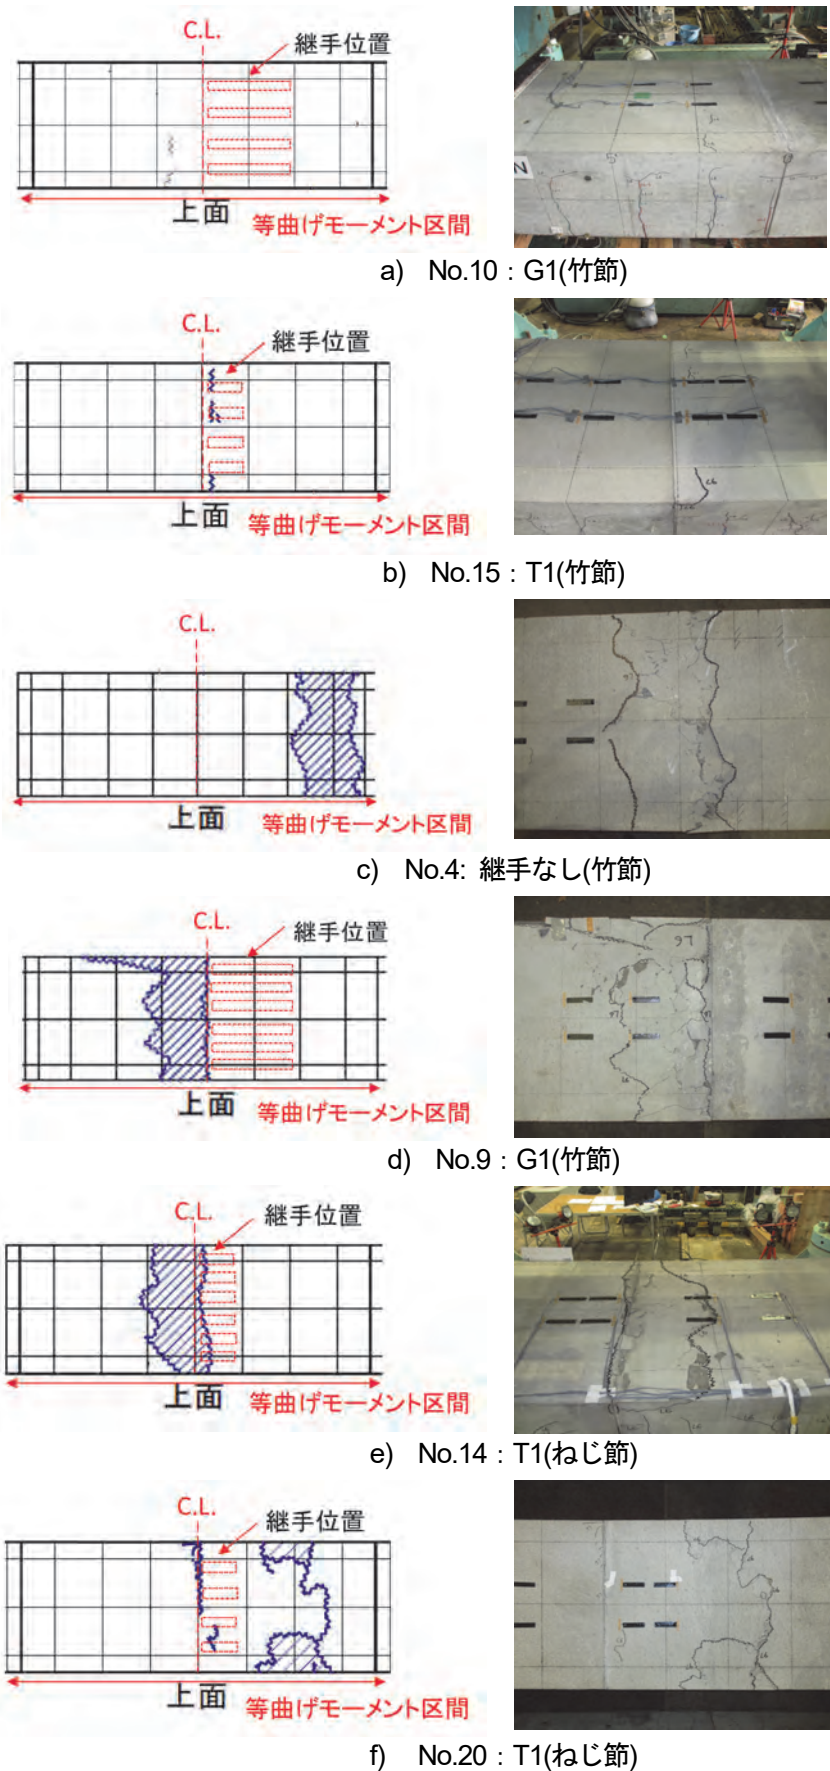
圧壊の発生状況（斜線部：圧壊部、波線：剥離によるひび割れ）
